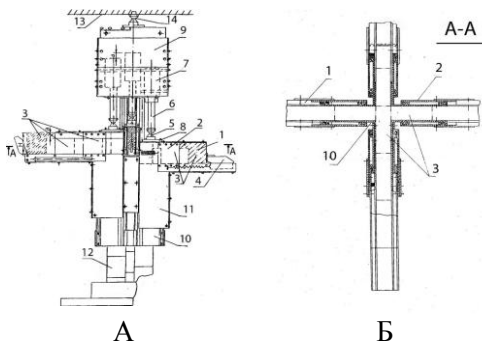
а. Загальний вид пристрою для монтажу надважких конструкцій Рис . 6-б. Розріз по А-А (вид зверху)
